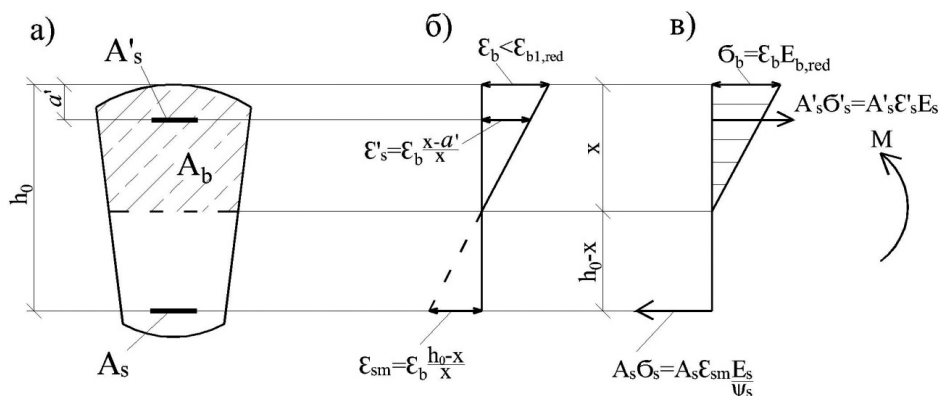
К определению кривизны для участка с трещинами изгибаемого элемента: а — схема сечения; б — эпюра усредненных деформаций арматуры и бетона; в — эпюра напряжений в сечении с трещиной
